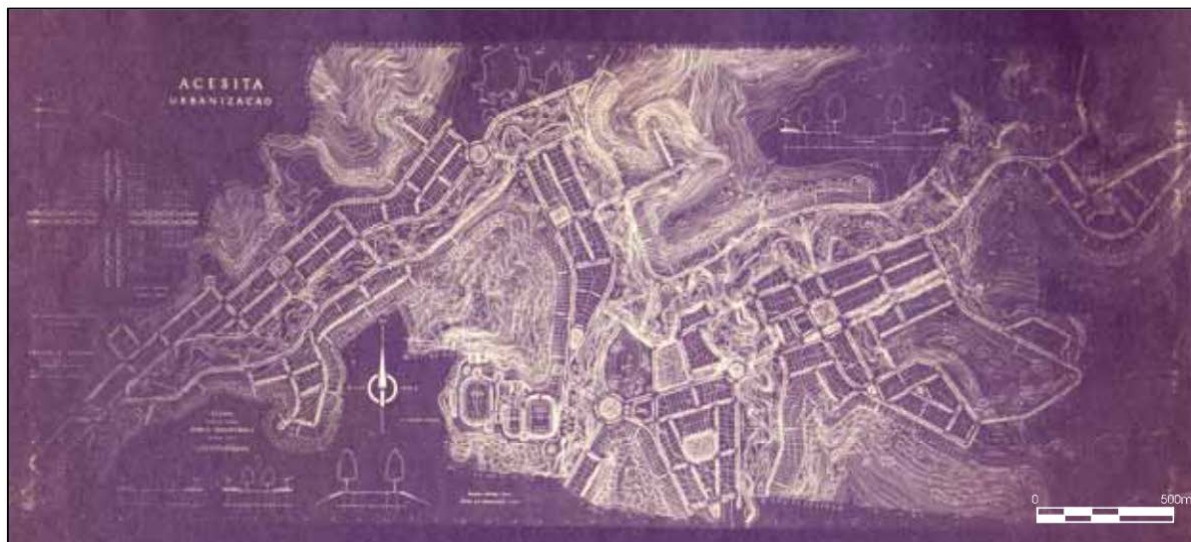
Plano Geral do projeto de Romeu Duffles para a ACESITA, 1947-51.
